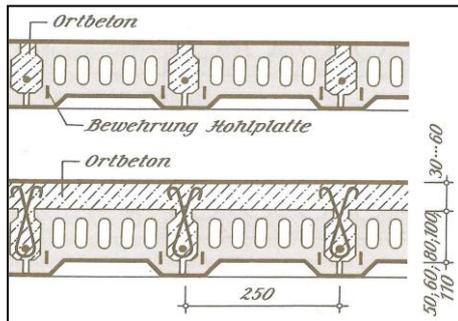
Deckensystem Stahlbetonhohldielen [1b]
